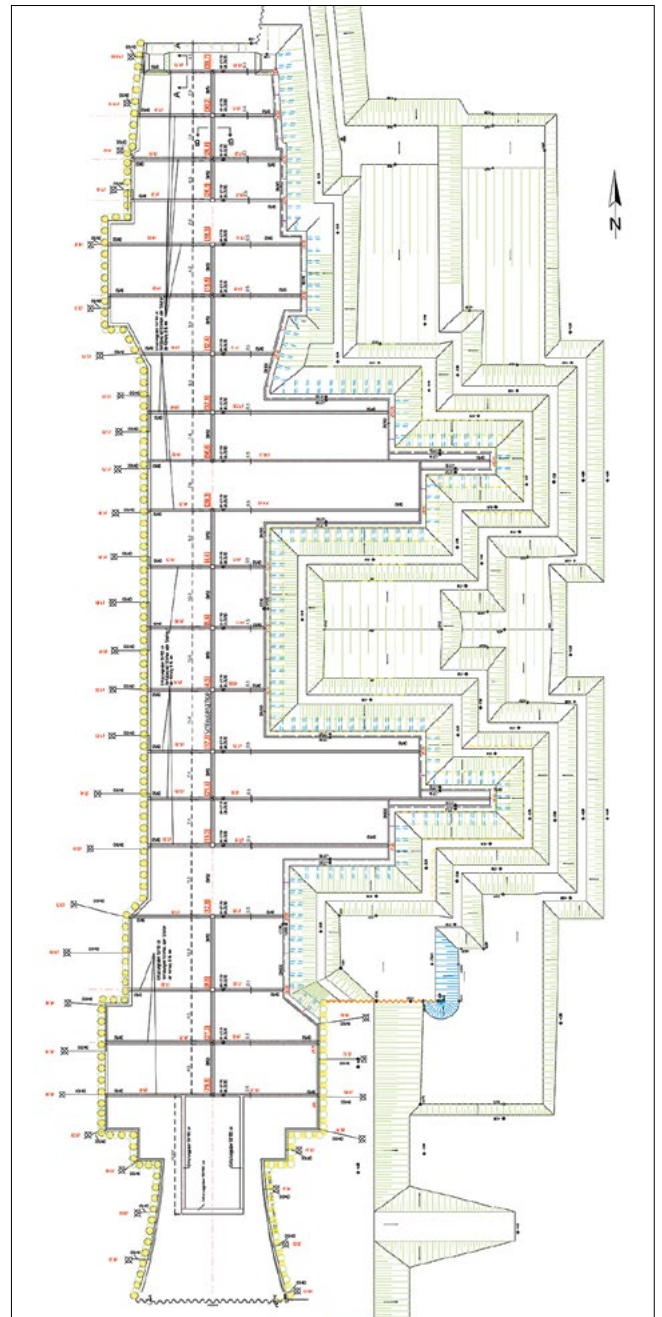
Dränagesystem zur Fassung der Grundwasserzuflüsse an der Baugrubensohle
